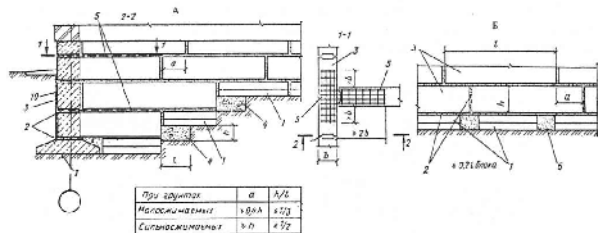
Детали конструкций сборных ленточных фундаментов: А – примыкание фундаментов наружной и внутренней стен; Б – деталь прерывистого ленточного фундамента; 1 – фундаментная плита; 2 цементно – песчаный раствор; 3 – бетонные блоки стен подвала; 4 – монолитный бетон; 5 – арматурная сетка; 6 – засыпной утрамбованный грунт
